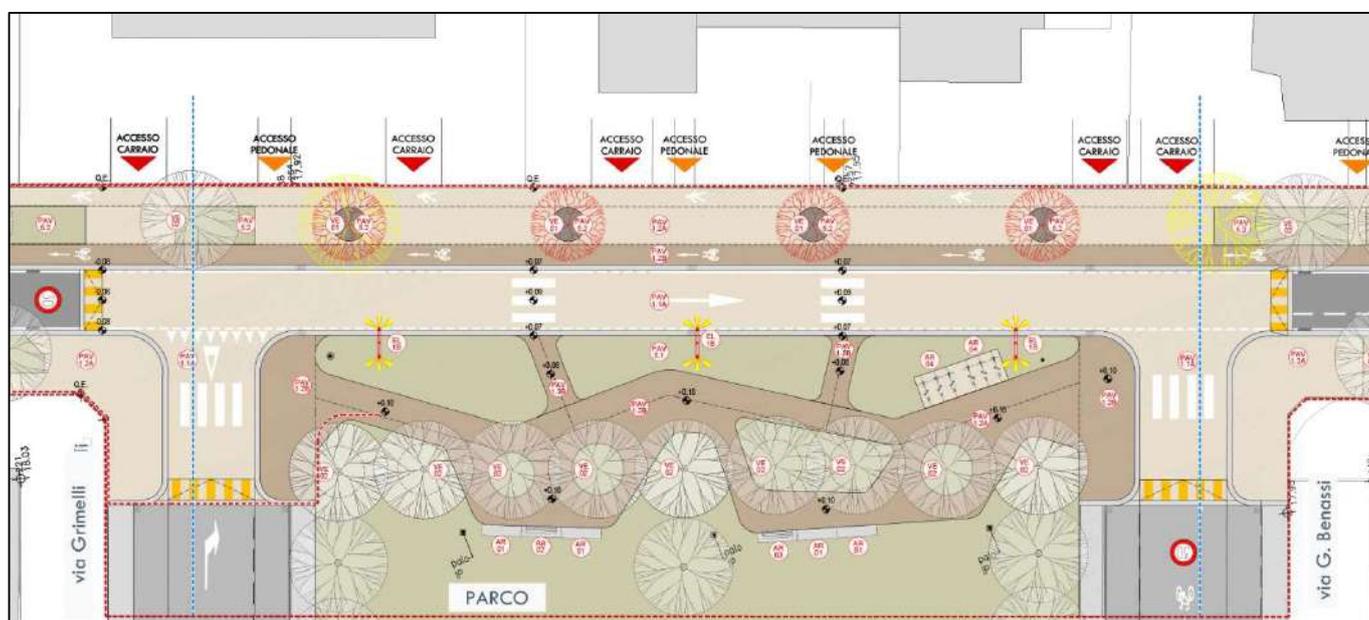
estratto planimetria di progetto Giardino del Duca Passerino
